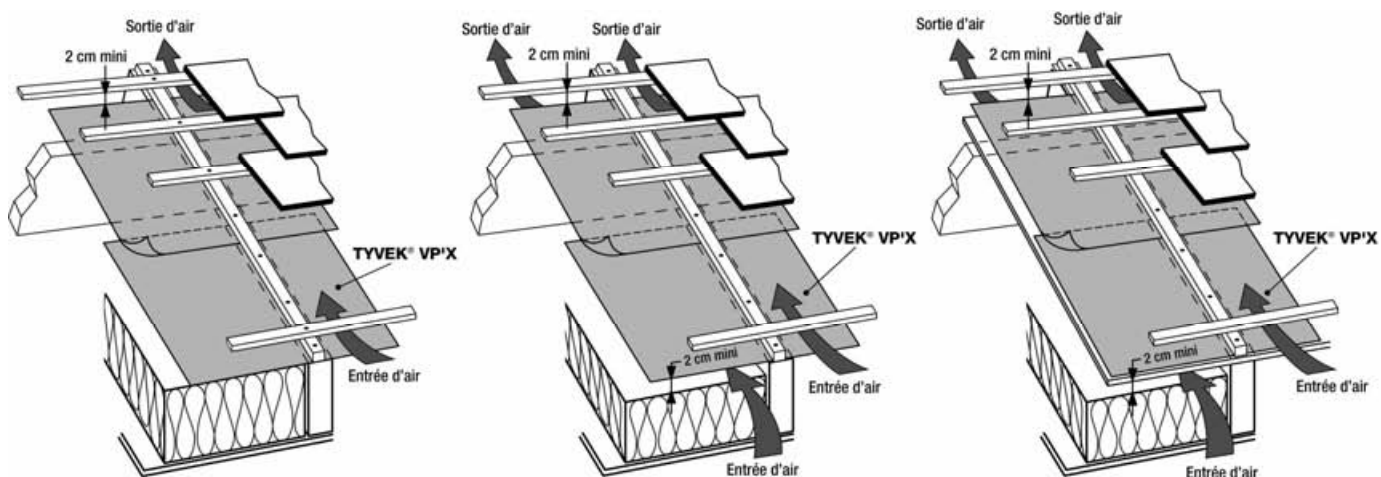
Ventilation - Pose directe sur isolant, pose ventilée en sous-face et pose sur support ventilé
